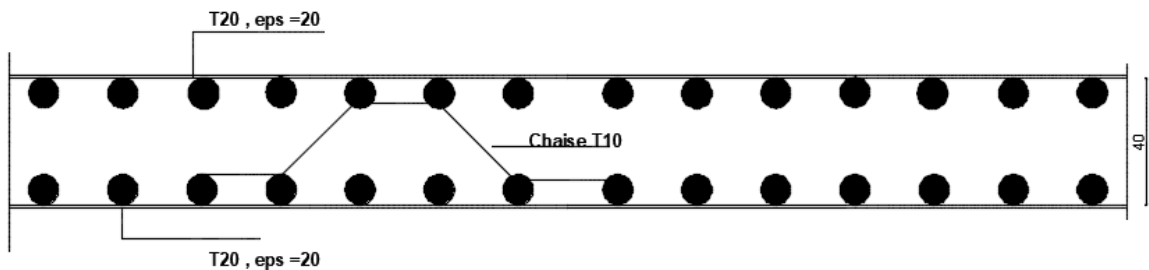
Schéma de ferrailage la dalle de radier
